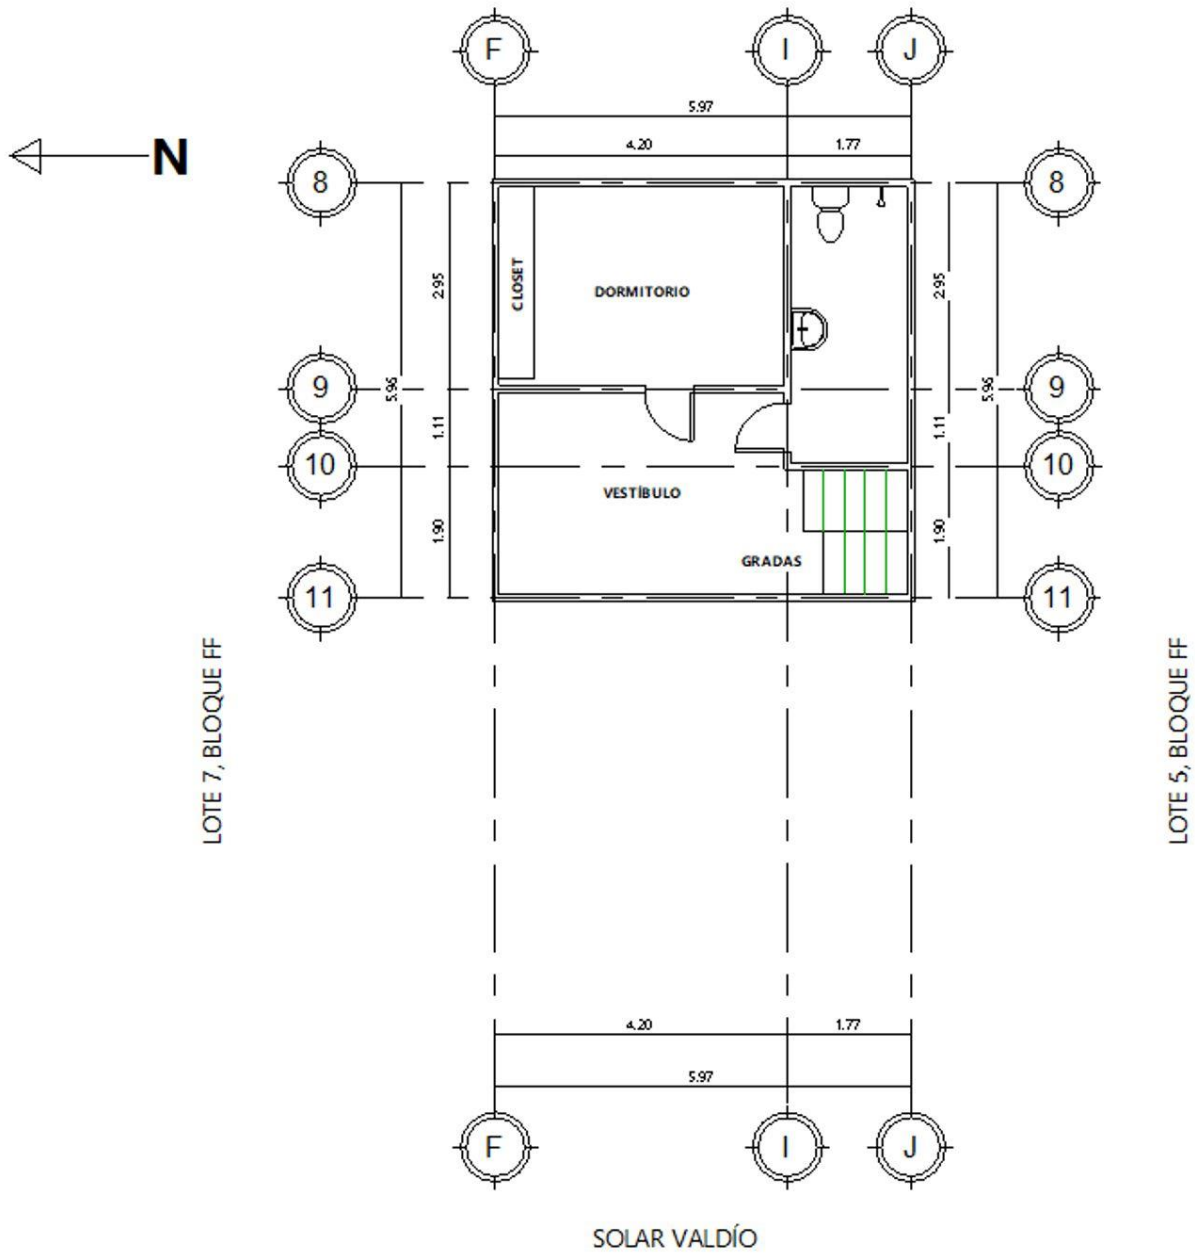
Planta arquitectónica del segundo nivel de la vivienda
